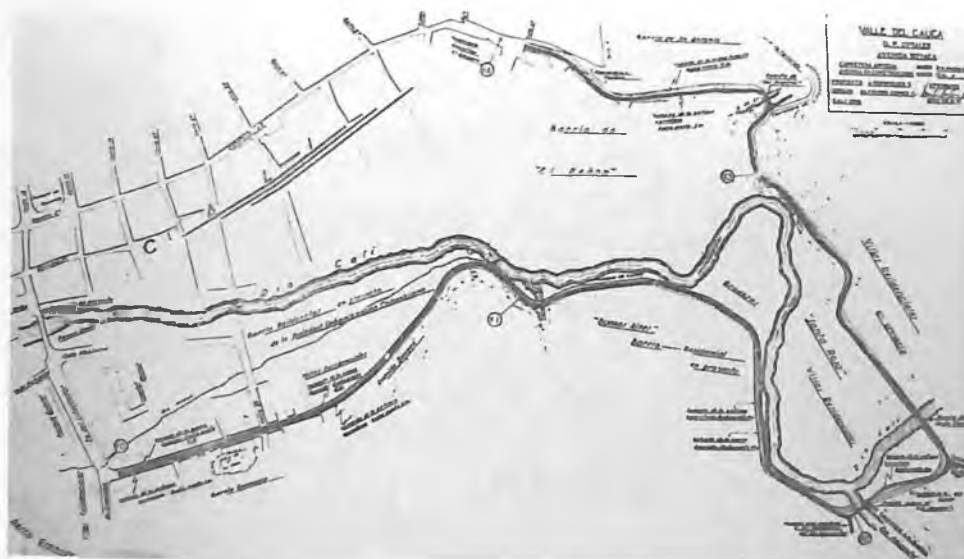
Trazado de la avenida Boyacá en el lado norte del puente de calicanto.
